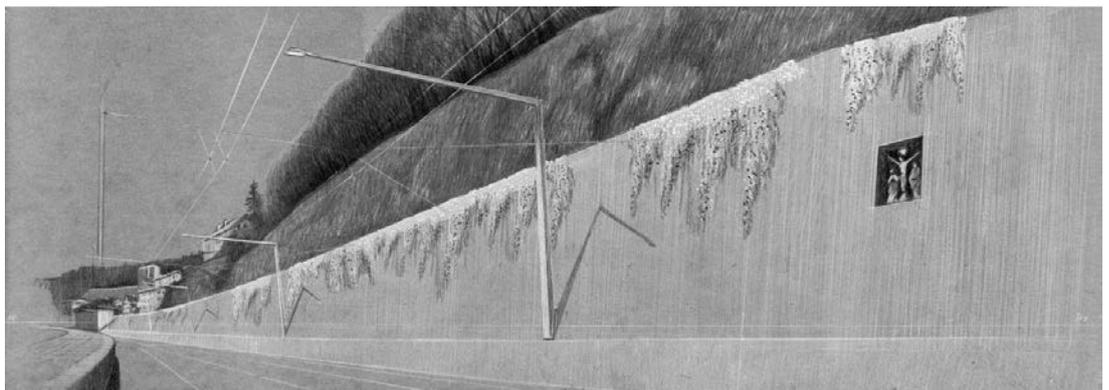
Standort Hauptstrasse in Blickrichtung Luzern mit bestehender Spritzbetonmauer und Einmündung Fluhmühlerain
